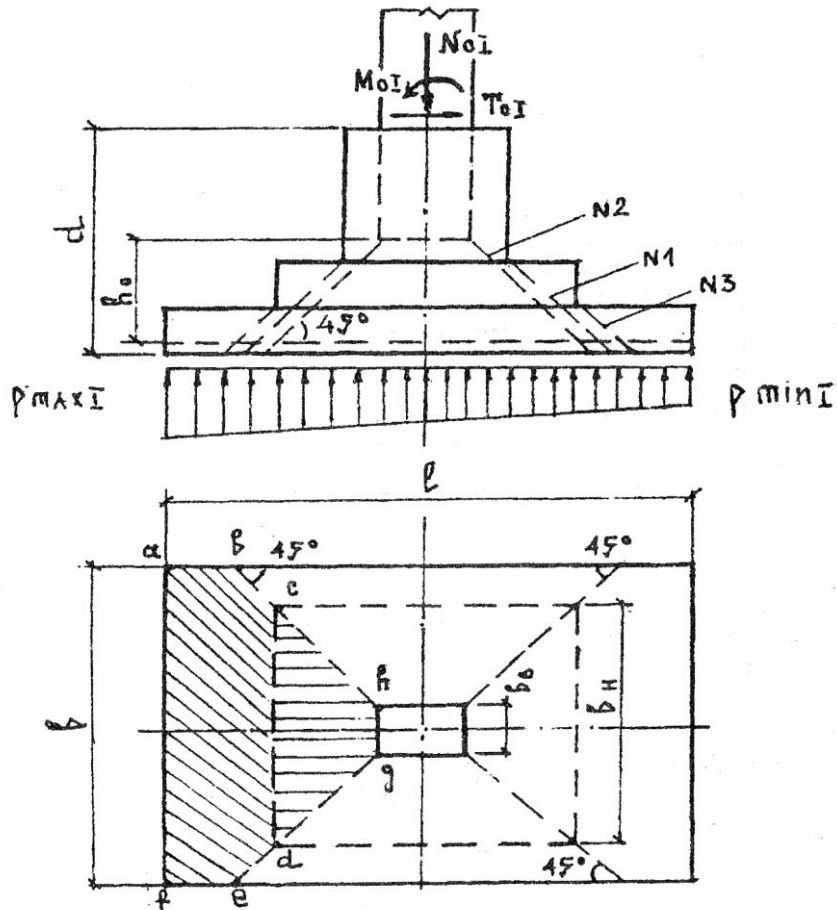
Возможные пирамиды продавливания в фундаменте под сборную железобетонную колонну
